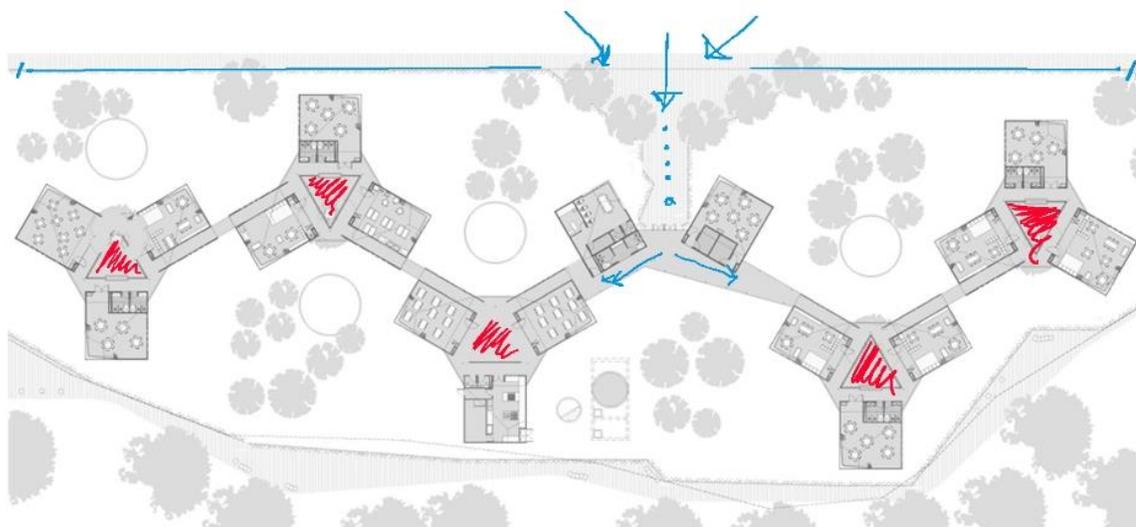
Planimetría de caracterización urbana. Fuente: elaboración propia
